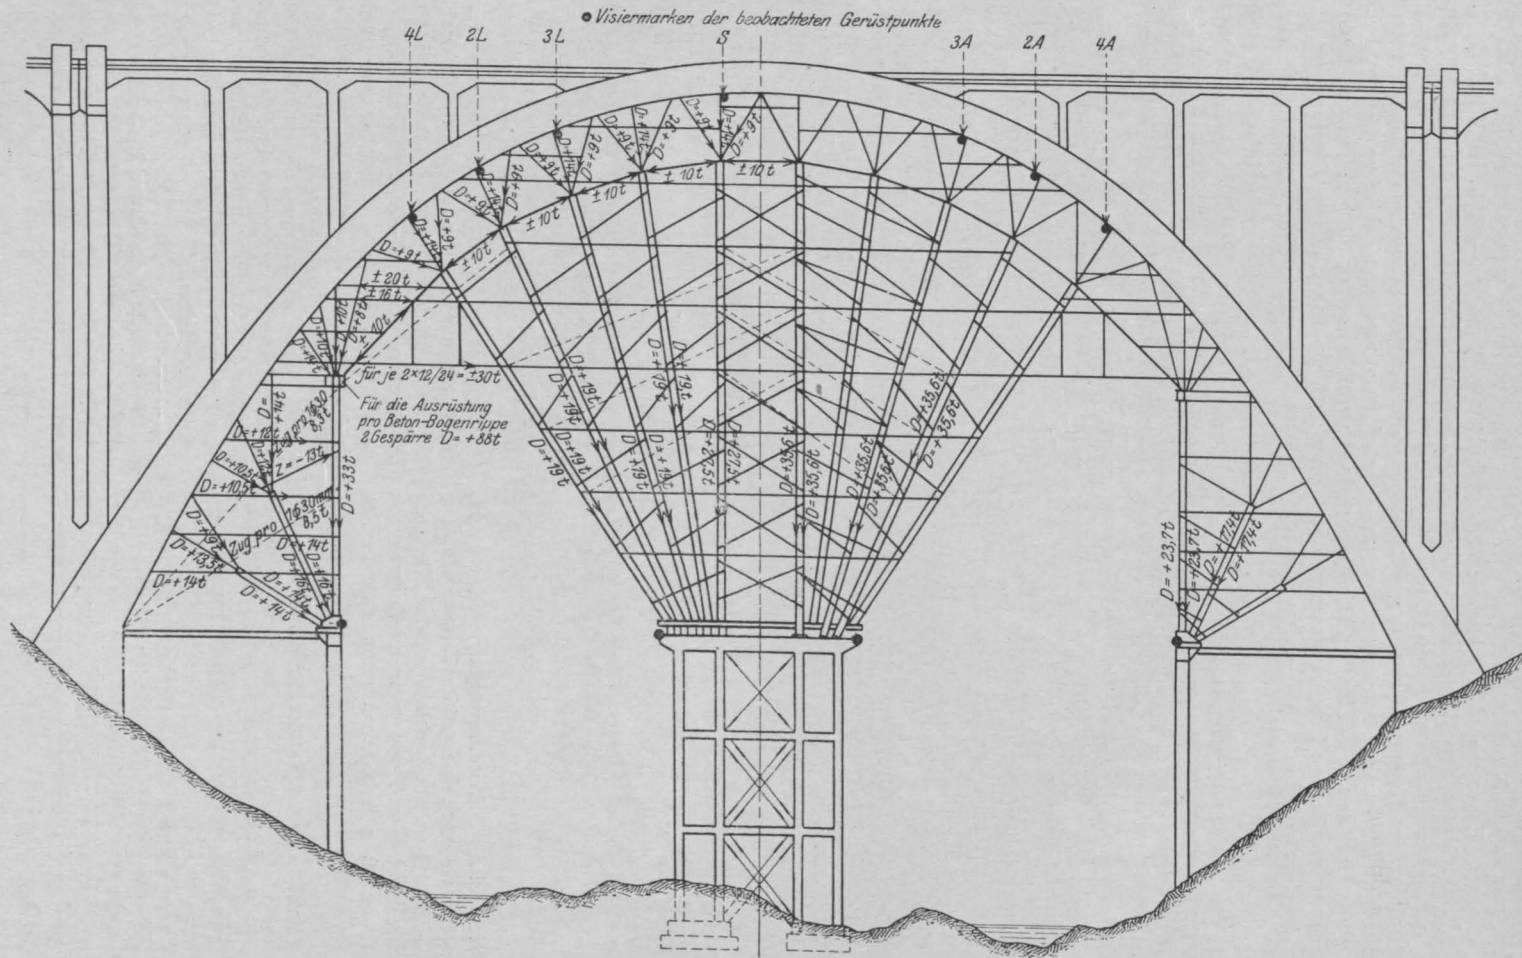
b. Kräfteplan des Lehrgerüsts.
